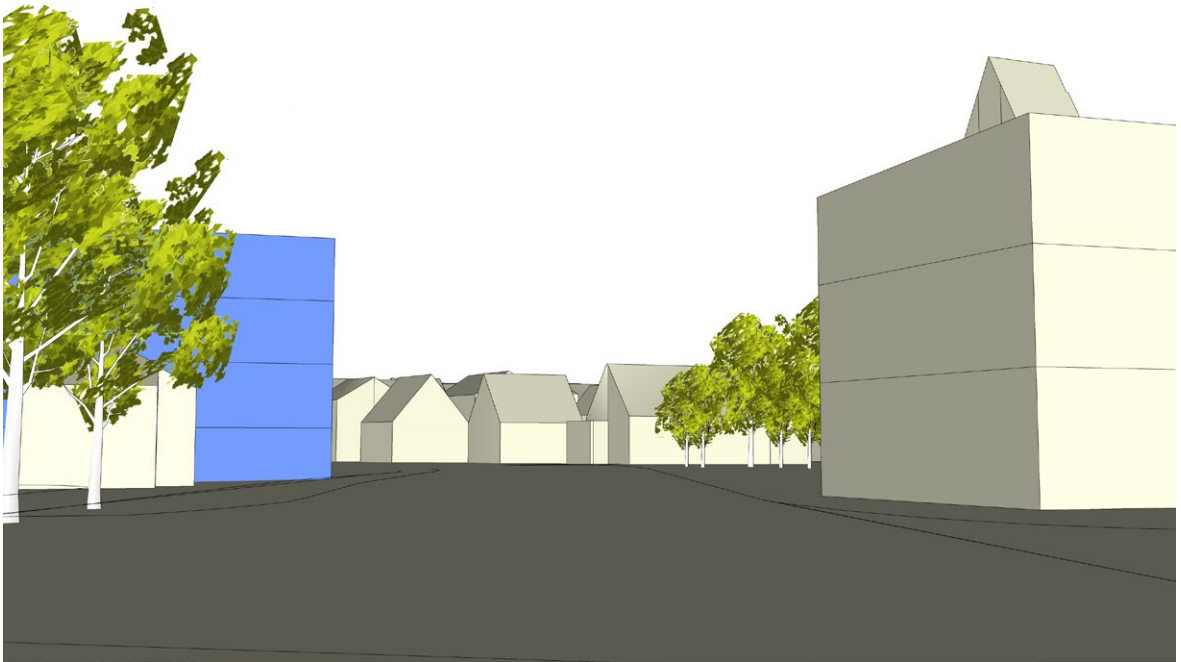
Kreisverkehr Kemptener Straße - bestehende Planung
